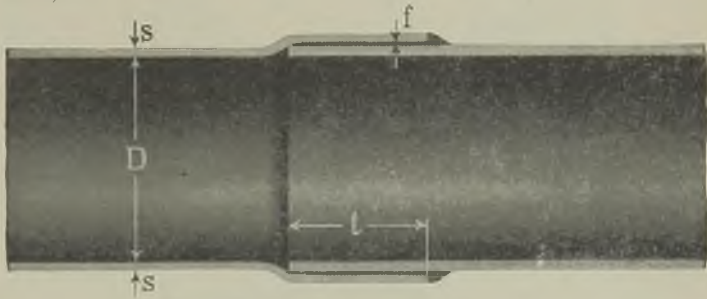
Normale Schweißmuffe für nahtlose Stahl-Muffenrohre (Ferngas-Versorgung). — Beim Verschweißen der Stirnfläche mit dem glatten Rohrende ist darauf zu achten, daß die Schweißnaht nicht flach, sondern möglichst gewölbt ausfällt. — Die Schweißmuffe ist heute bei Leitungen unter Druck allgemein üblich. (Röhren-Verband, G. m. b. H., Düsseldorf.)
